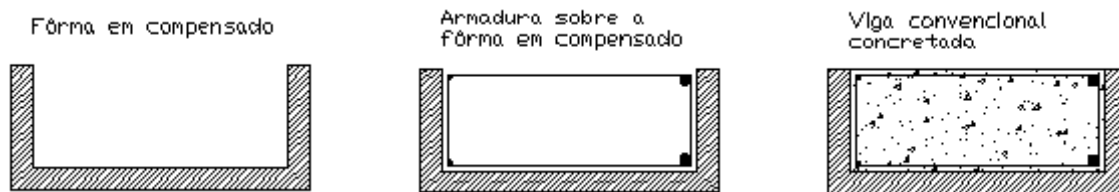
Esquema de fabricação da viga convencional (MASSONI, 1996)
